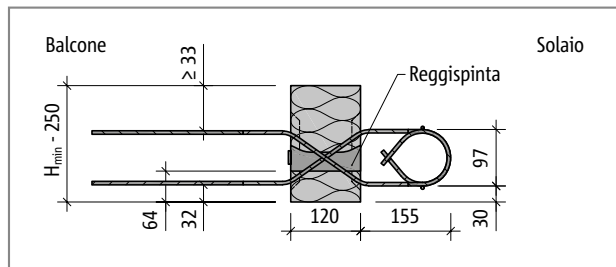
Schöck Isokorb® tipo da QXT10+QXT10 a QXT40+QXT40: sezione dell'elemento
